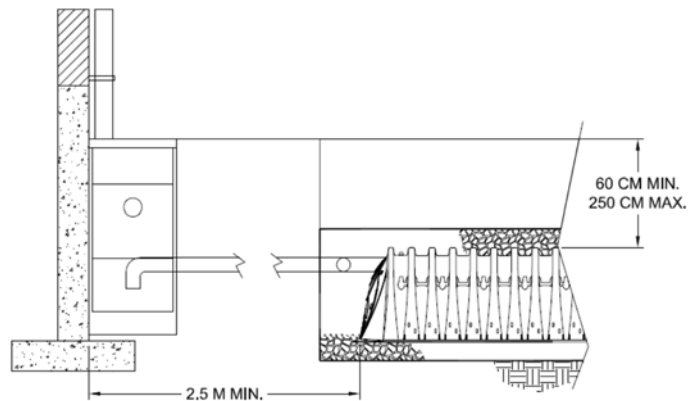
Plan de détail d'admission – exemple d'une application maison individuelle pour une chambre STORMTECH SC310
